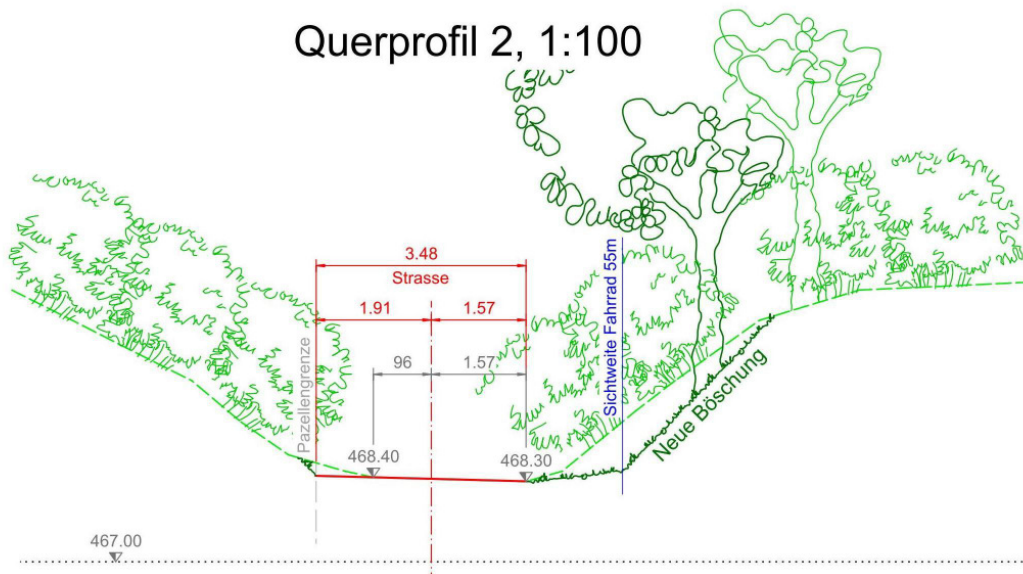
Anpassungen Wilergasse, Querprofil oberhalb der Einfahrt
